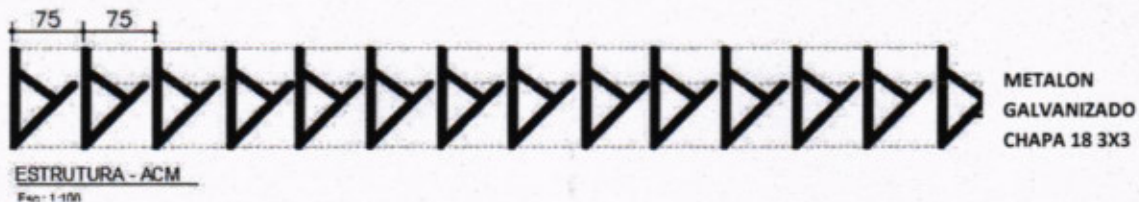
Detalhamento da estrutura. Metalon 3x3 chapa 18.
